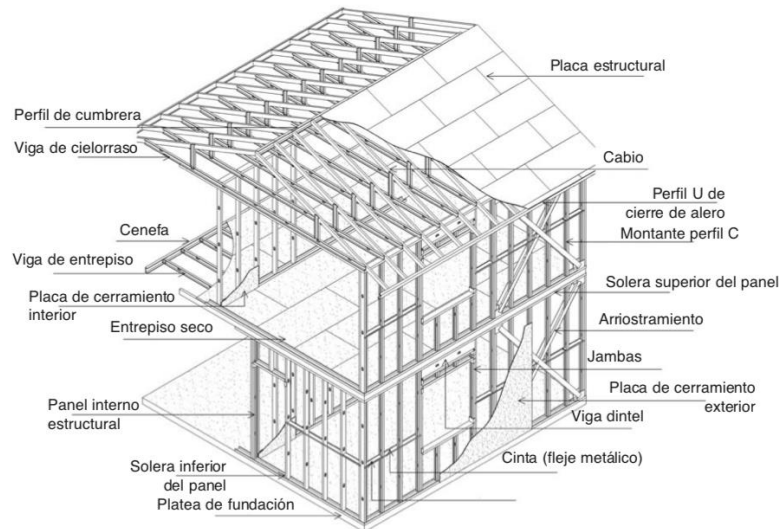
Componentes de una vivienda construida con Steel Framing. Fuente: Steel Framing arquitectura, "Alacero".
